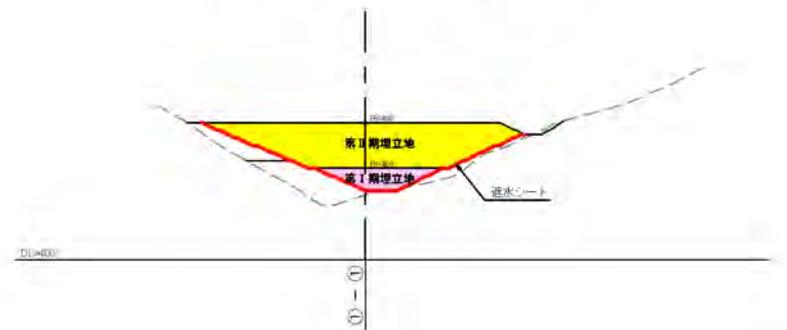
埋立地縦横断面図 (S=1:5,000)
